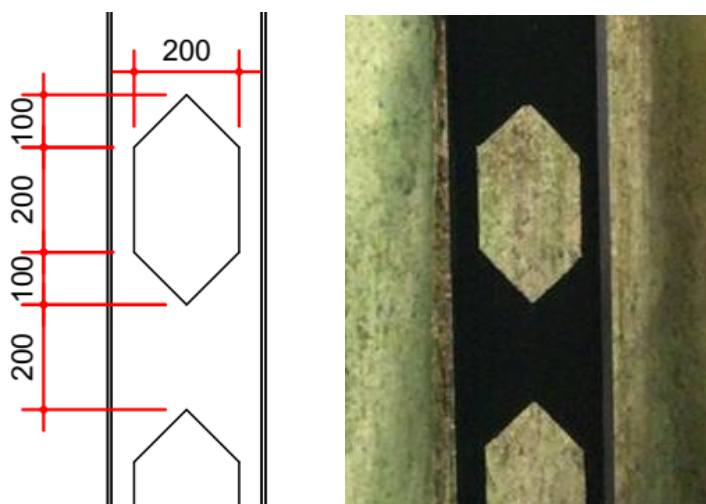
VISTA TÍPICA DOS PILARES (DIMENSÕES EM MM)
